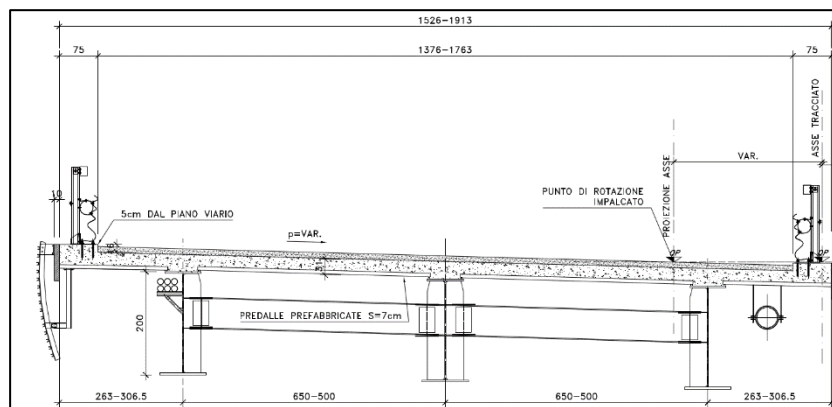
Sezione trasversale Ponte tipo impalcato tipo in campata
